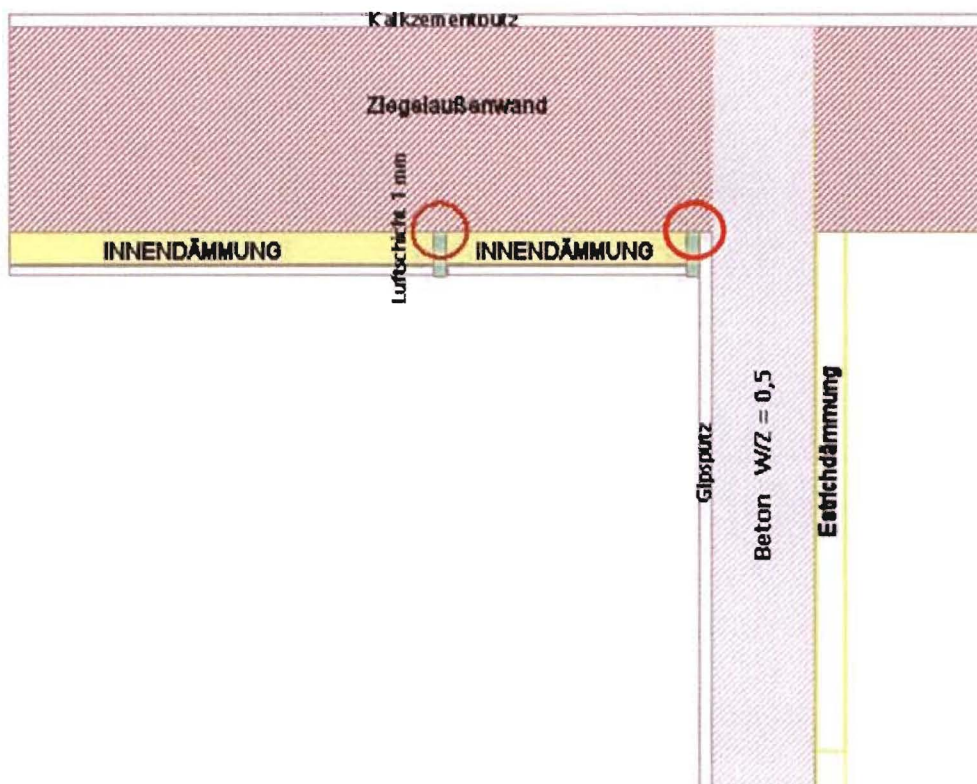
Implementierter Wandaufbau mit einer Betondecke, die oberseitig mit einer Estrichdämmung versehen ist und bei dem zwischen Decke und Innendämmung durch eine unfachgemäße Anbringung ein Luftspalt vorhanden ist.
